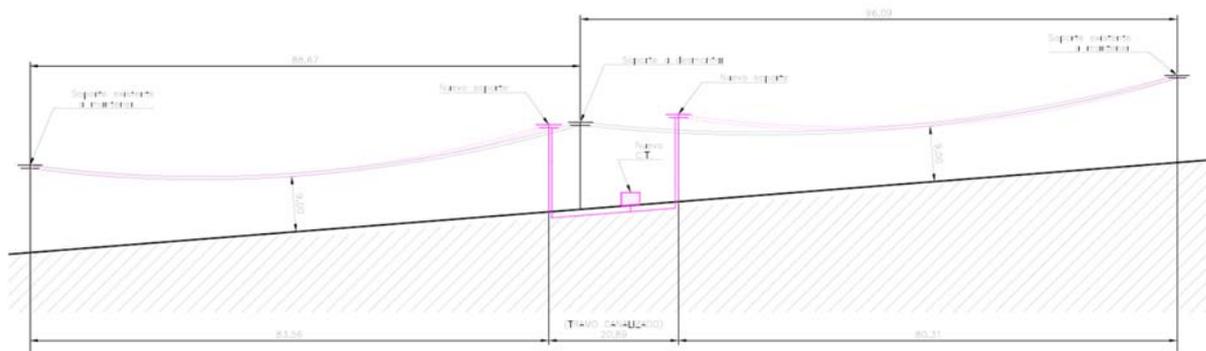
Alzado red aérea existente: Instalaciones proyectadas y ubicación poste MT a desmontar
